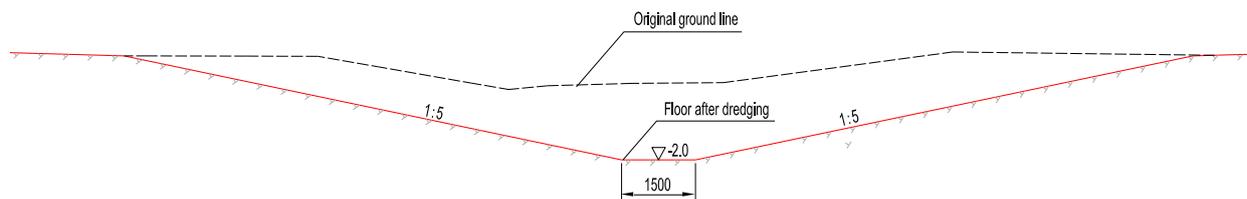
Coupe typique de l'ouvrage de dragage
